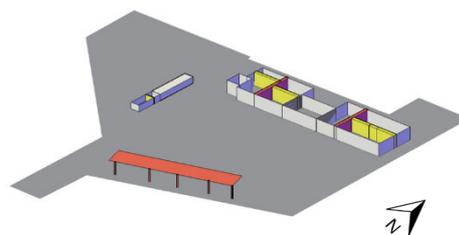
Modello Residenza corte Fenice-demolizione/ricostruzione.
